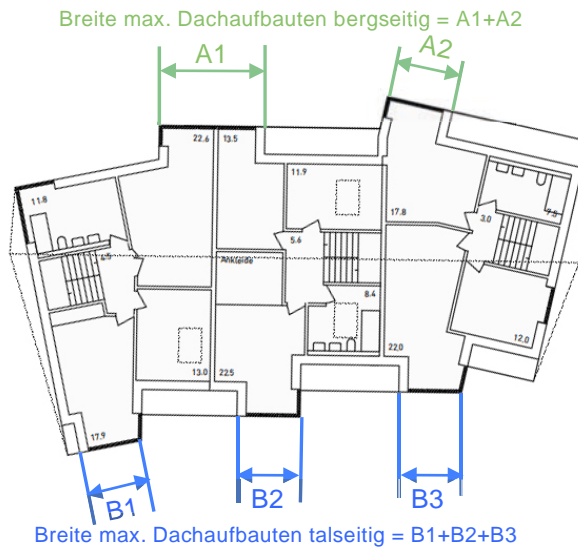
exemplarische Darstellung Messweise Dachaufbauten
